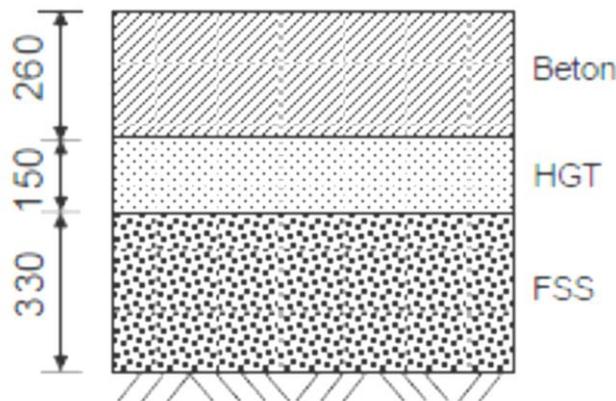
Schichtaufbau einer Betonfahrbahn
